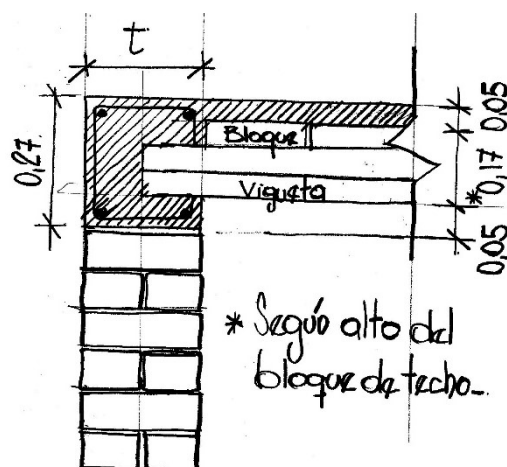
Encuentro Encadenado horizontal superior y losa viguetas
